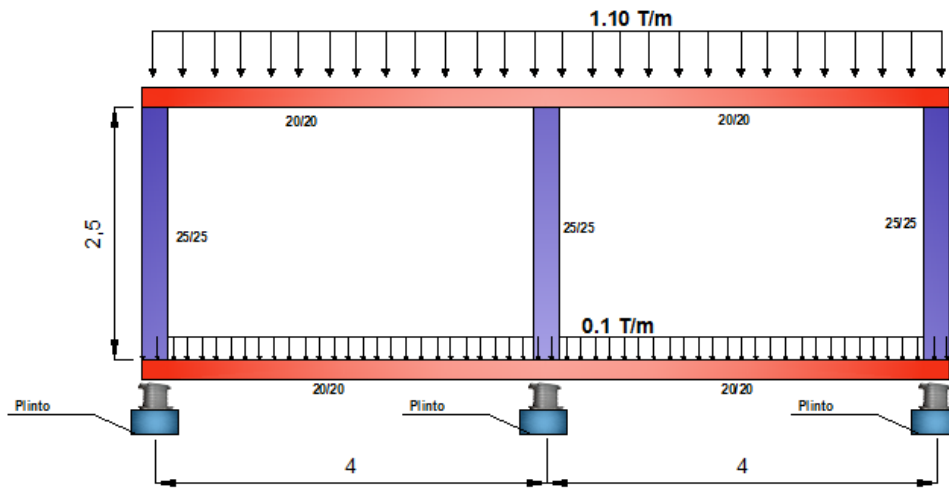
Vista elevación pórtico 2 y detalle de conexiones de la superestructura y la cimentación con el aislador
